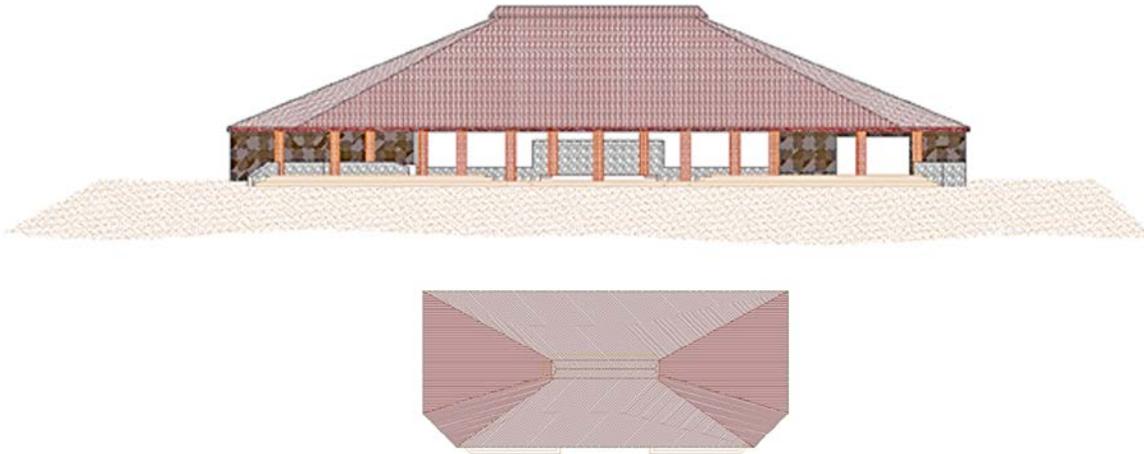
Vista de fachada principal y vista de techo de la palapa. Fuente promovente.
